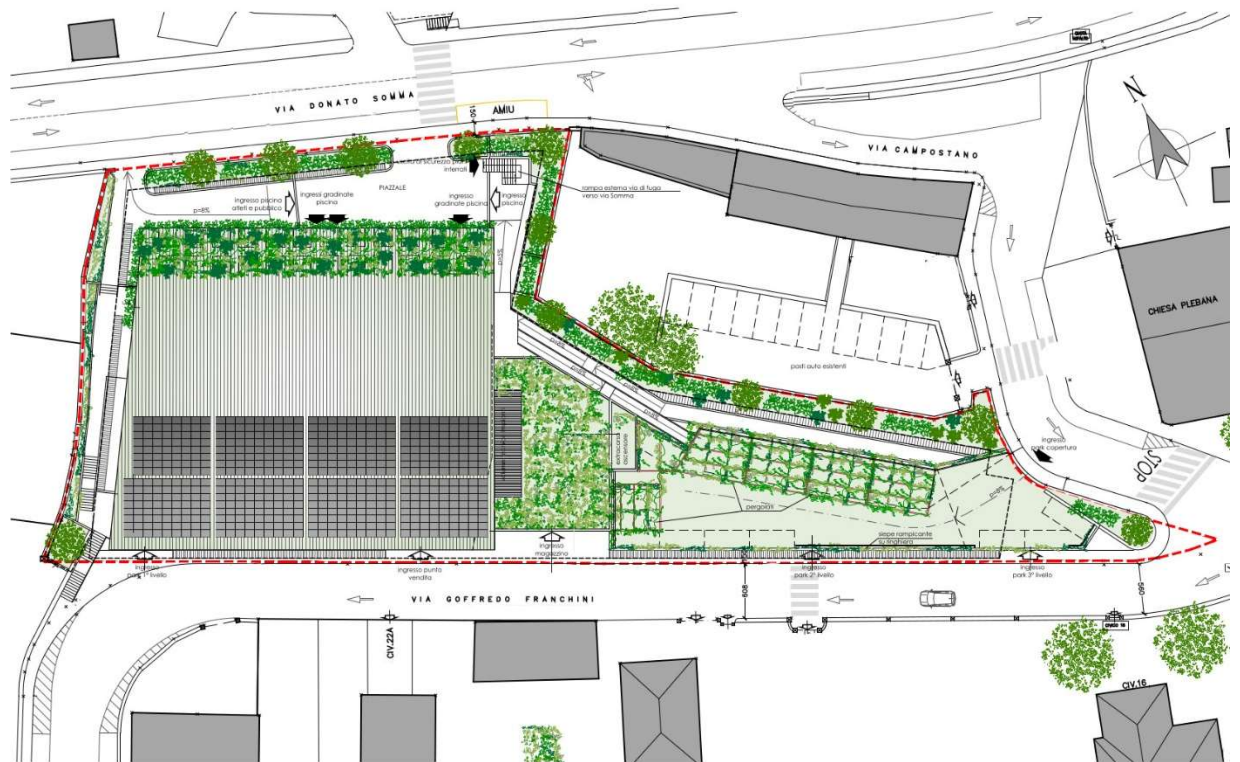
planimetria generale di progetto, in rosso l'area di intervento.
